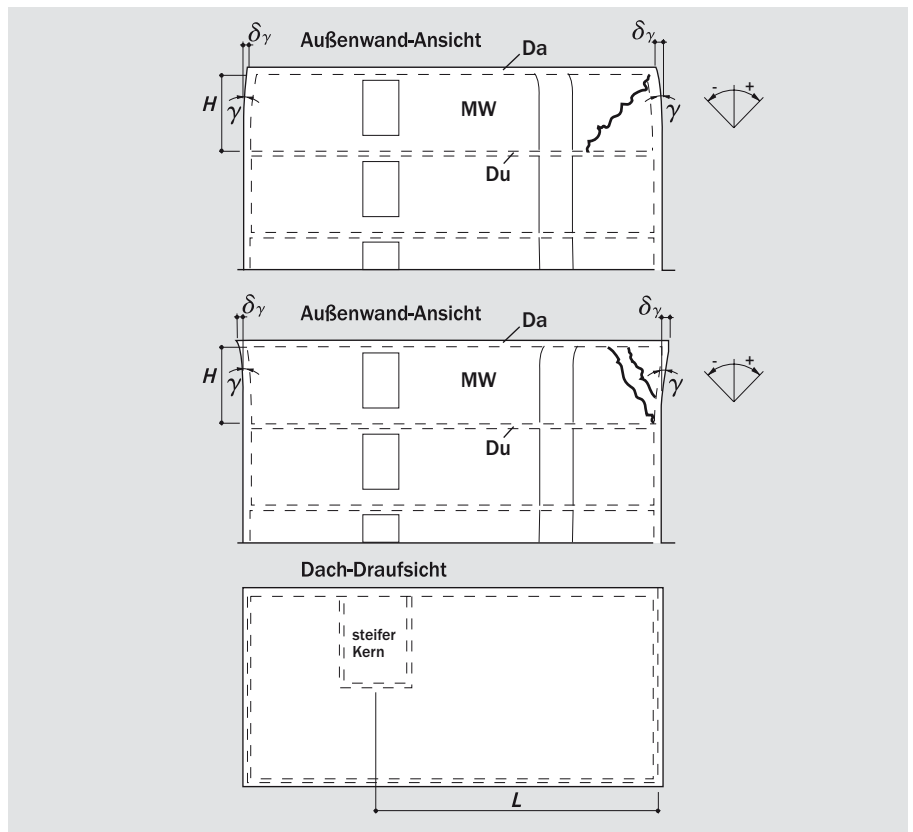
Verformung bei unterschiedlicher Temperatur von Dachdecke und Unterkonstruktion (Ansicht Außenwand). Da = Dachdecke, Du = Decke unter Da, MW = Mauerwerkswand.
